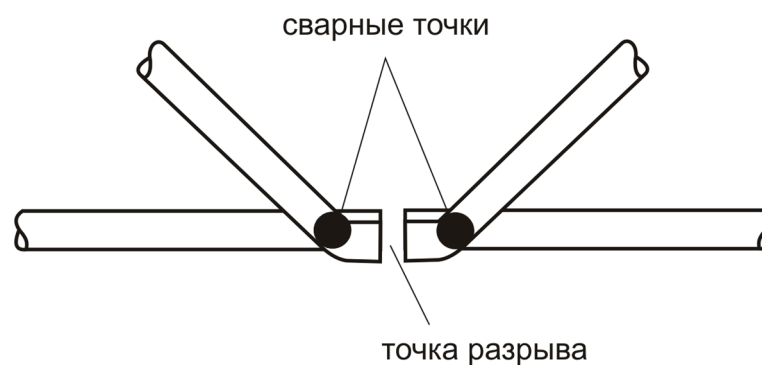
Образец для испытания с двумя сварными соединениями.
